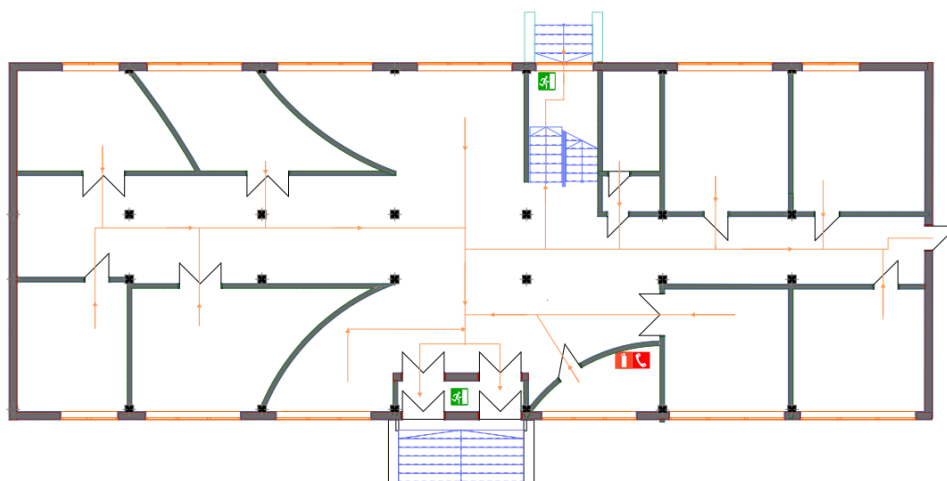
Схема евакуації 1-поверха 9 корпусу
